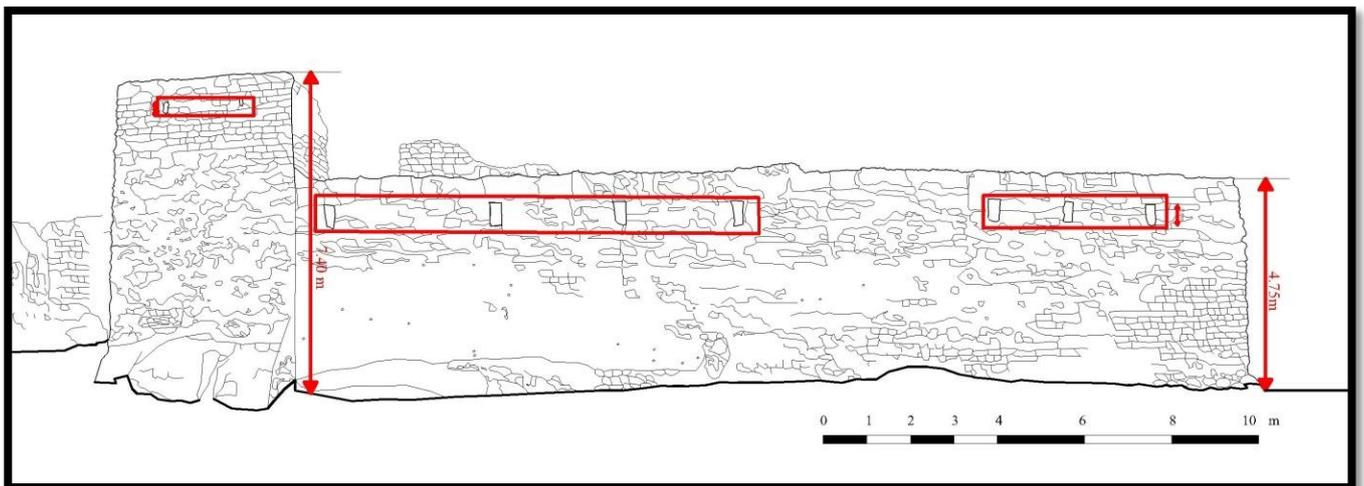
façade extérieure sud; fenêtre de muraille et tour.
